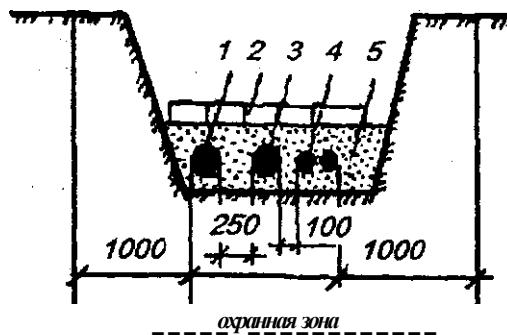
Прокладка кабелей в траншее: 1 - кабель на напряжение 35 кВ; 2 - кирпич или железобетонные плиты; 3 - кабель на 10 кВ; 4 - контрольные кабели; 5 - мягкий грунт или песок
